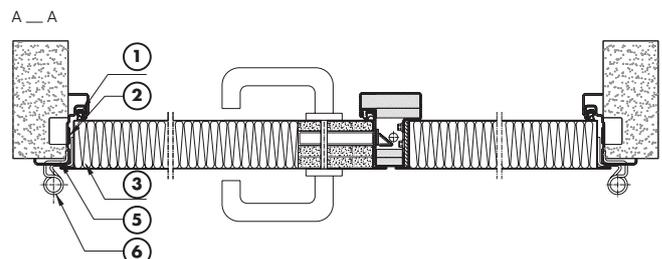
Zweiflügelige, großformatige Stahl-Mehrzwecktüren mit Eckzarge – Horizontal-schnitt
